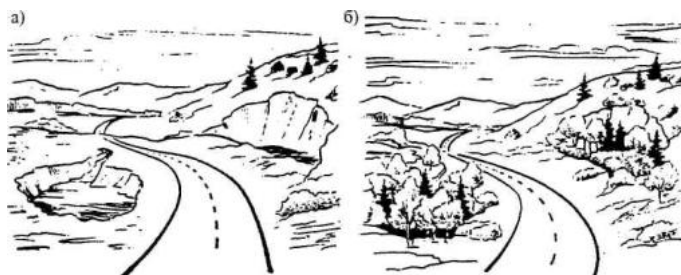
Маскировка грунтового карьера посадкой деревьев:
